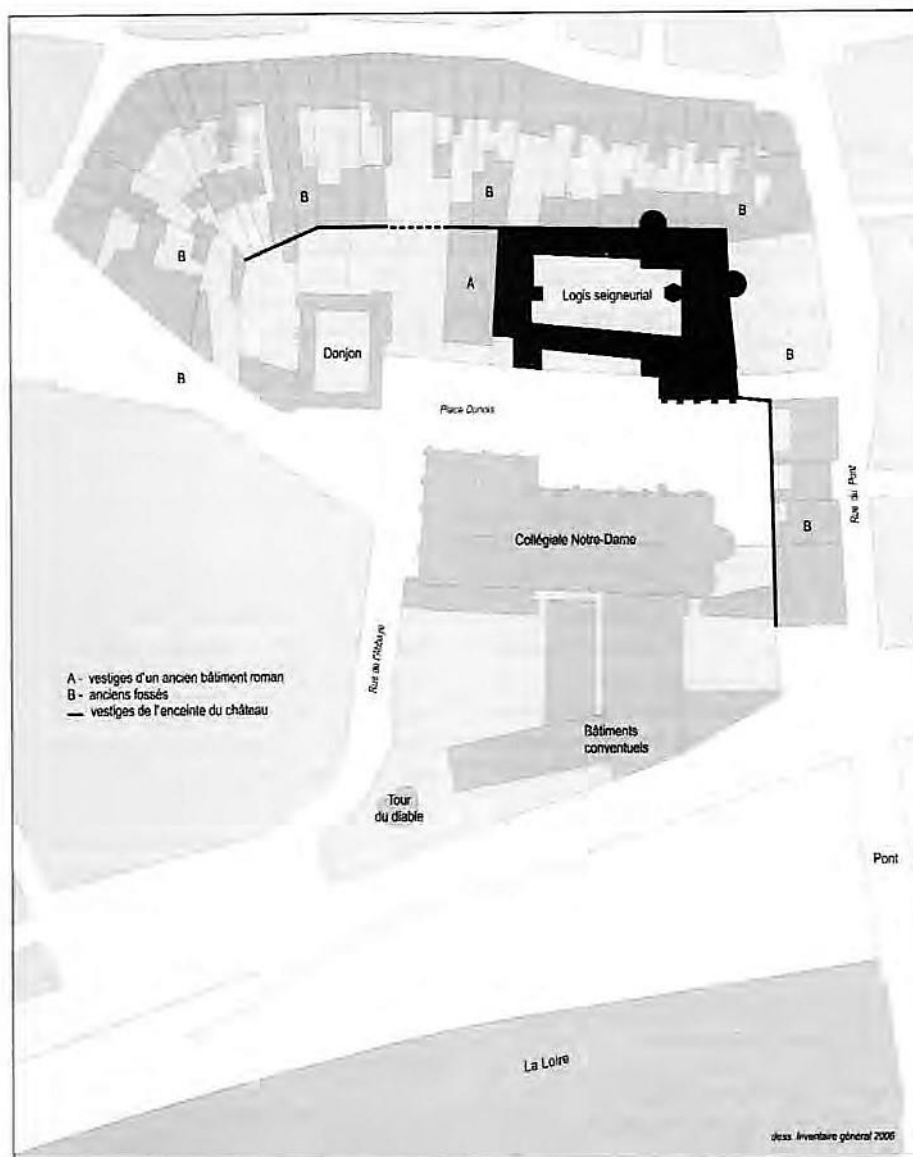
Beaugency, plan-masse et plan de situation de l'ensemble castral (dessin A.-M. Bonnard © 2006, Inventaire général Centre-ADAGP).
